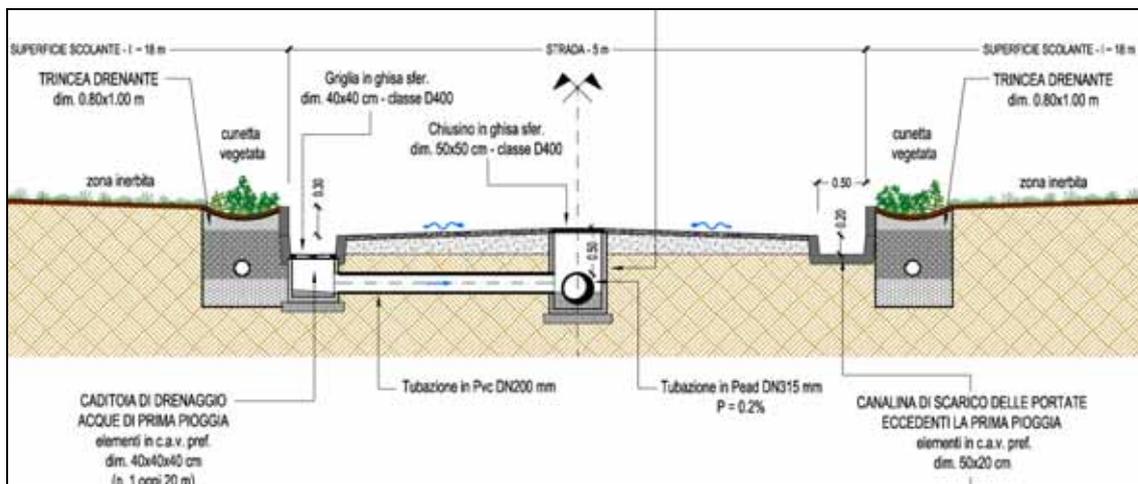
Sezione tipologica sistema di drenaggio “duale”
